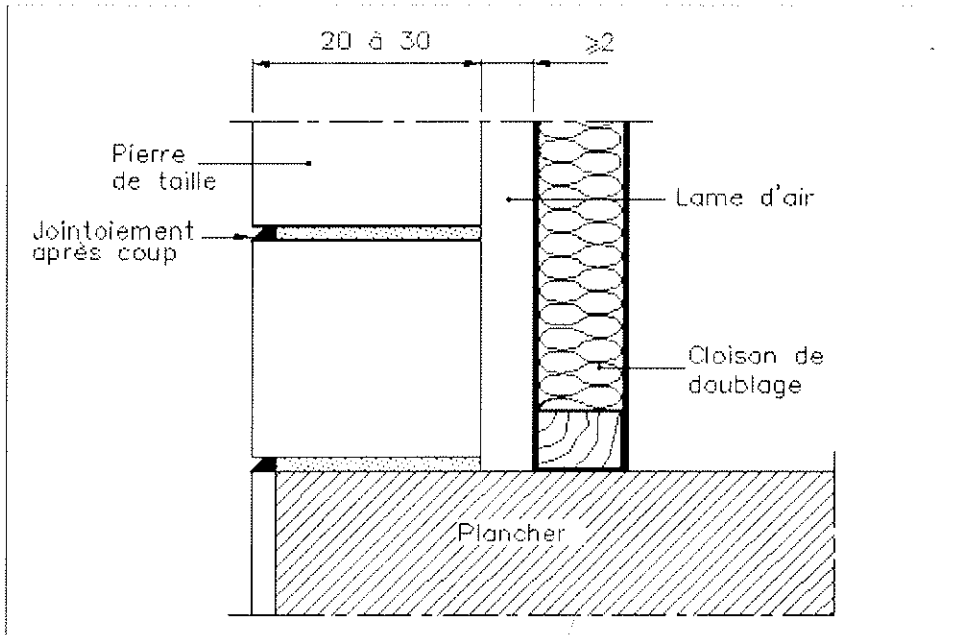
Moellons taillés ou pierre de taille/murs du type IIb/épaisseur minimale de la paroi extérieure en pierre
